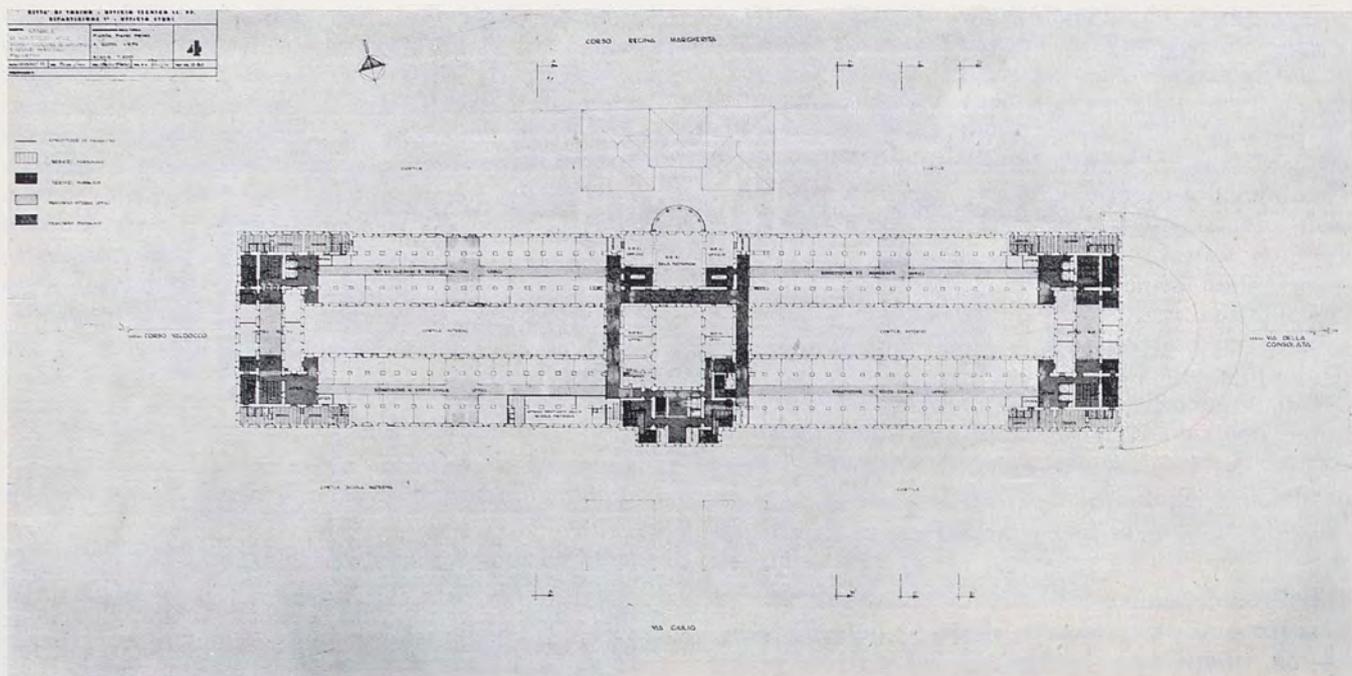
c - Il progetto di ristrutturazione: pianta del primo piano.
